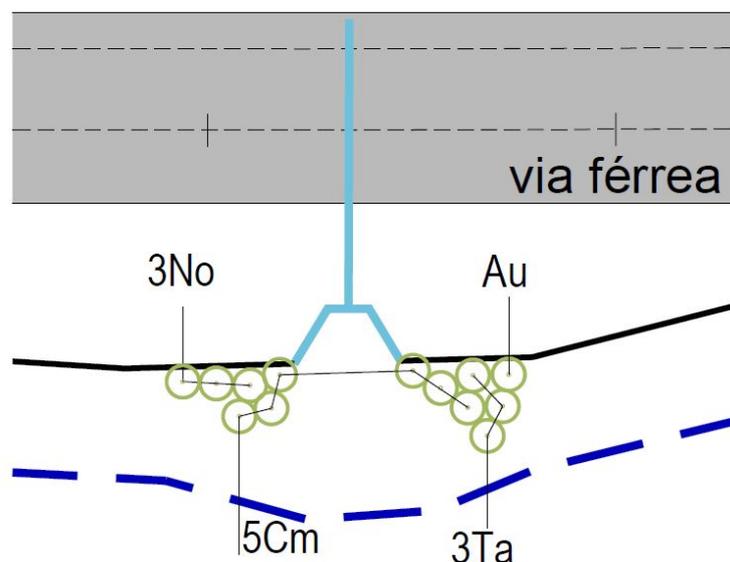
Módulo 4 - Módulo de plantação arbustivo a colocar nas passagens hidráulicas (sem escala).
